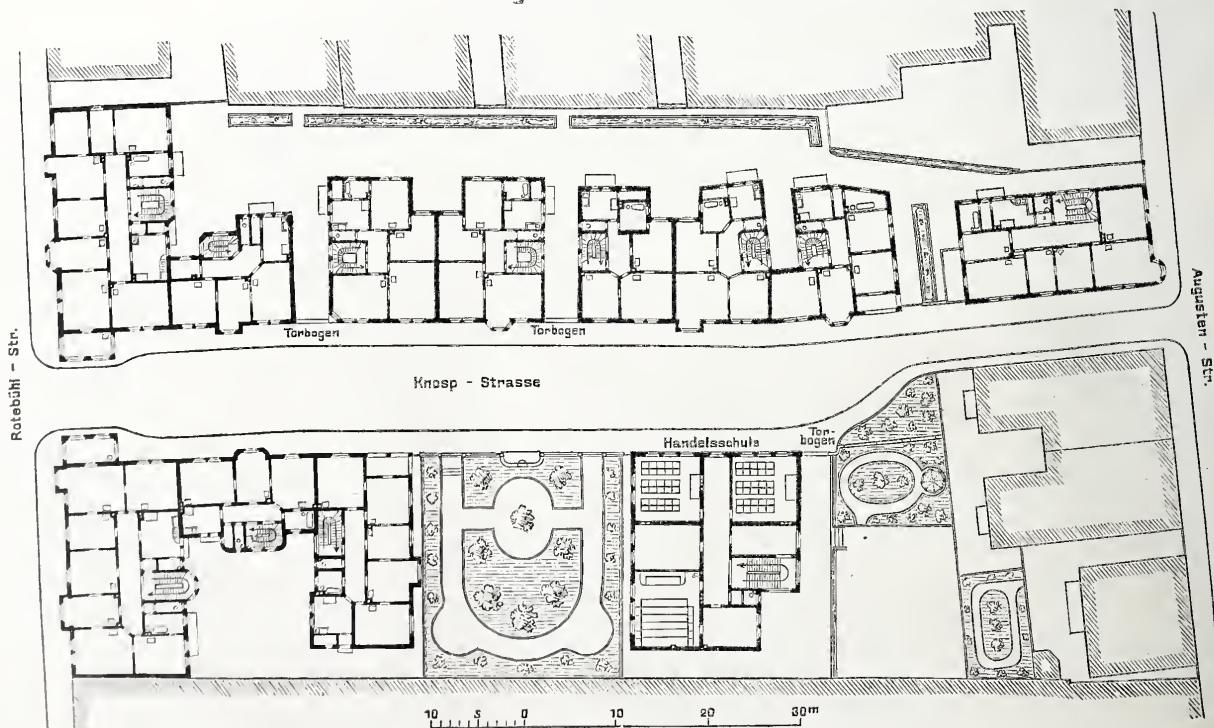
Grundrisse der ersten Stockwerke.
